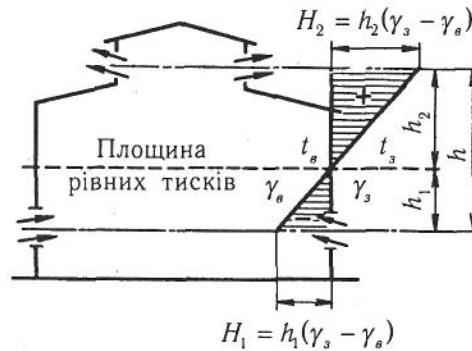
Розподіл тиску повітря у будівлі внаслідок дії теплового напору
